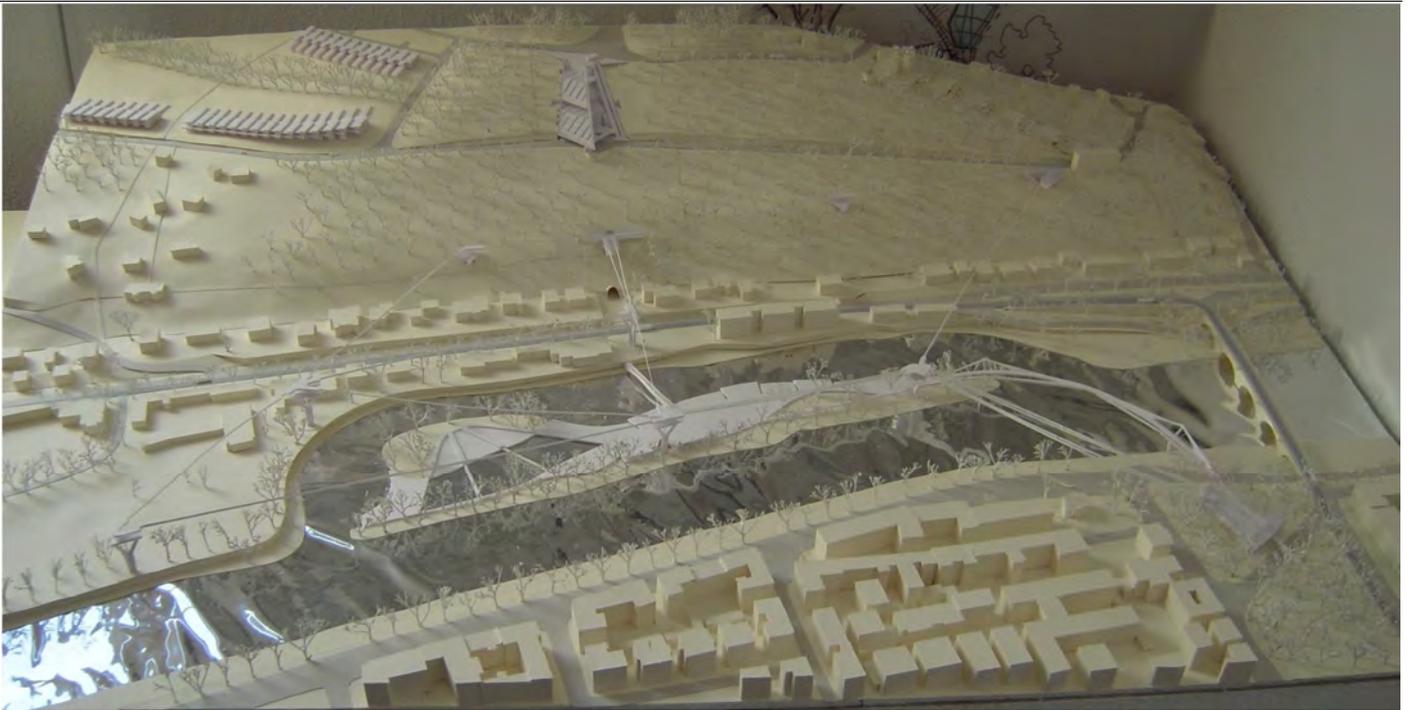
Modellbau; Städtebau, Projektgebiet, M 1:1000
